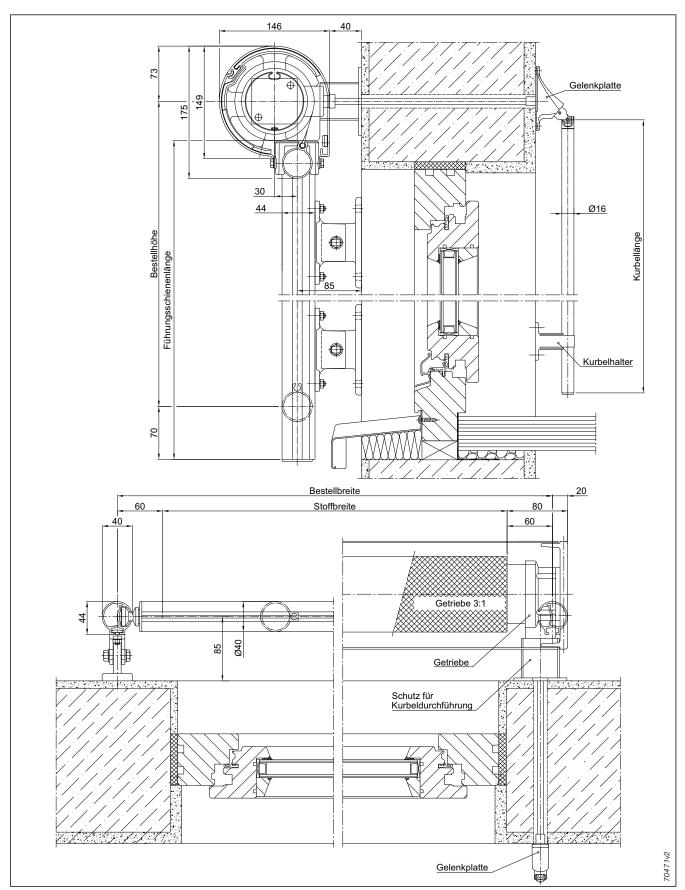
Fassaden-Markise 201 mit Rundblende Typ 8.3, Kurbelantrieb
